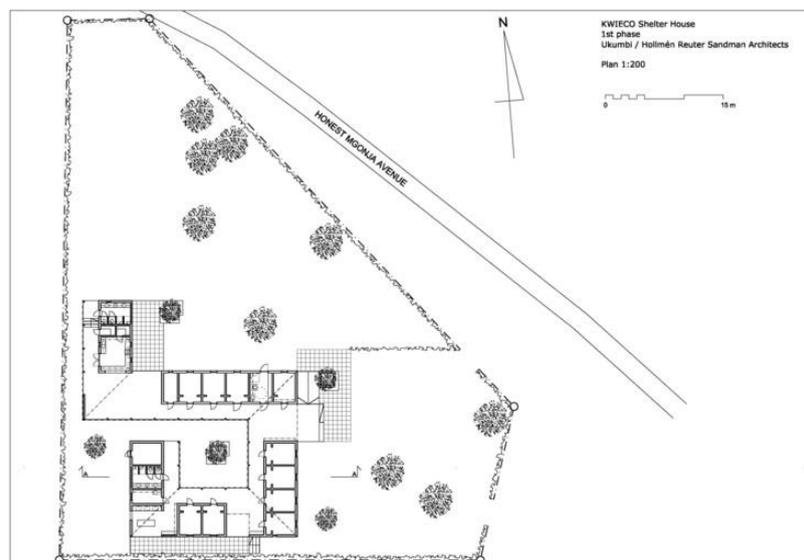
Planta Baixa do projeto kwieco, Fonte: Archdaily Brasil.
